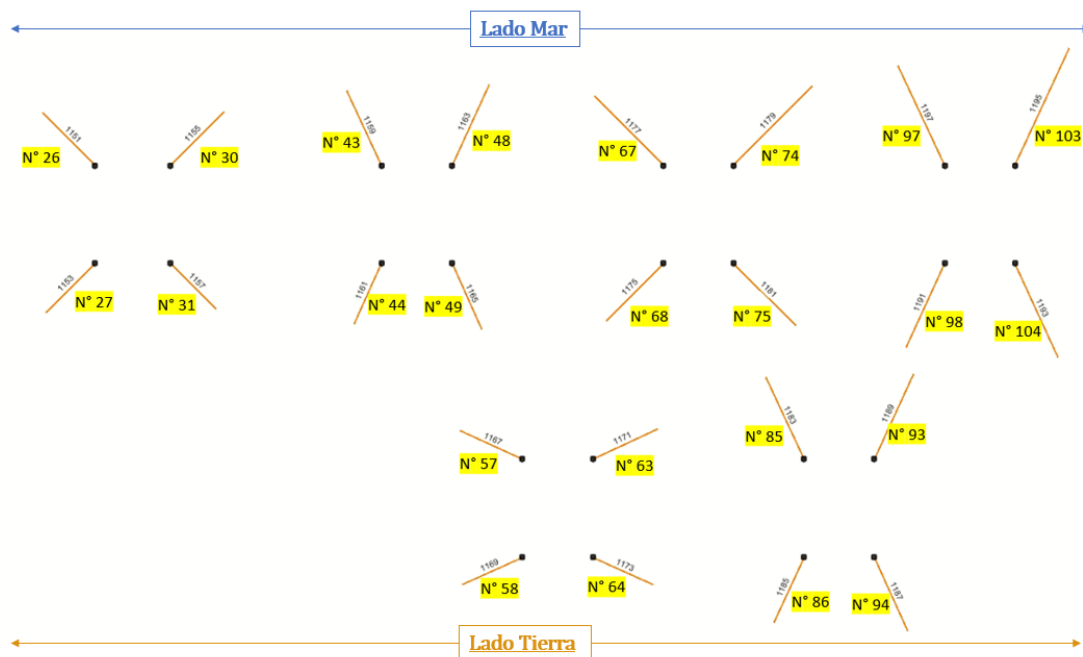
Identificación pilotes inclinados. Vista en planta
